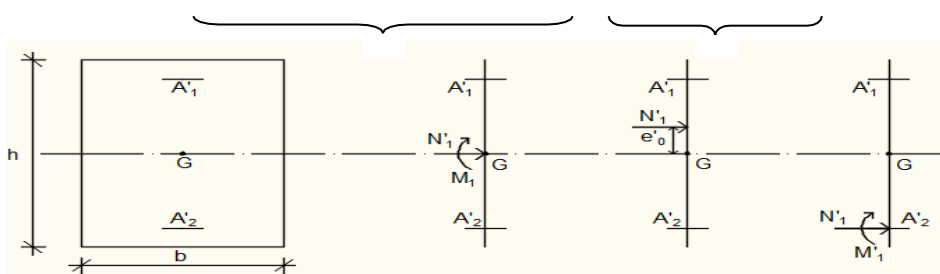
Position de N'1 M'1 et M1 sur la section transversale.
